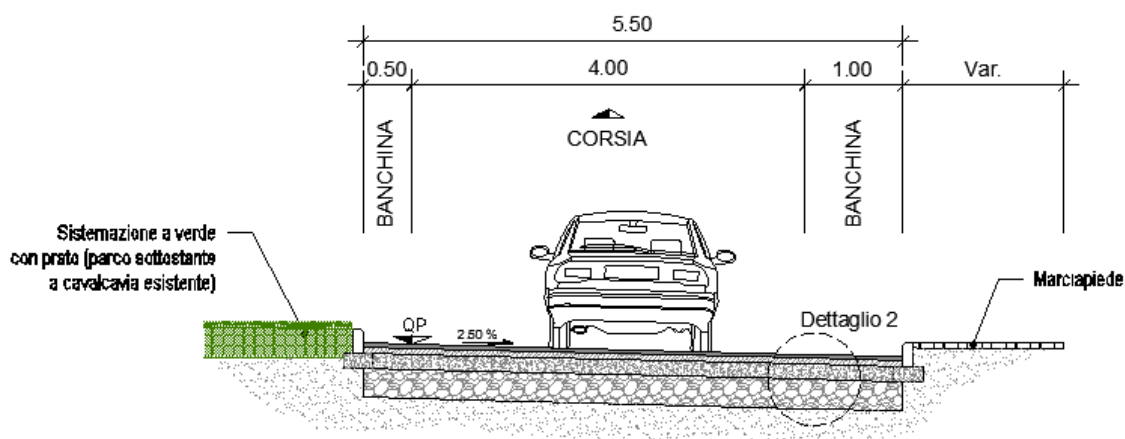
sezione tipo in affiancamento alla nuova sistemazione a verde
